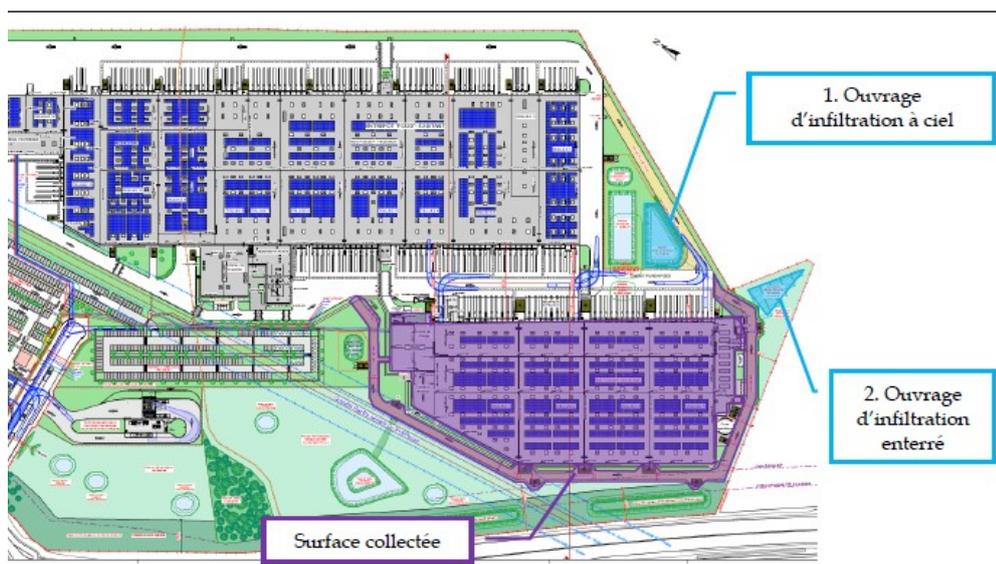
ouvrages d'infiltration des eaux pluviales de toiture
